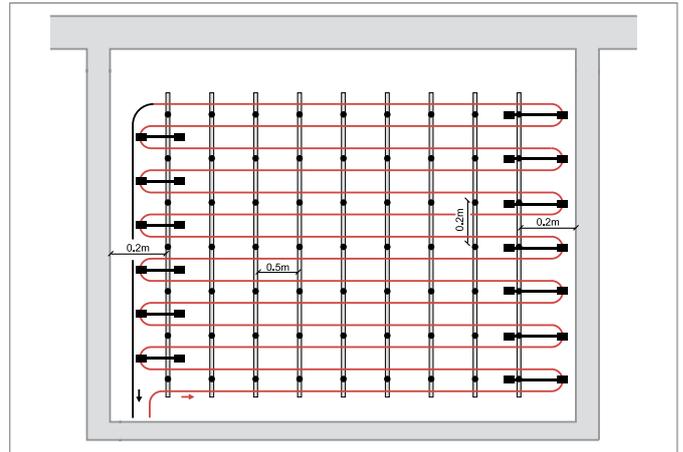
Disposizione a meandro semplice, VA 10 (vista parete)
